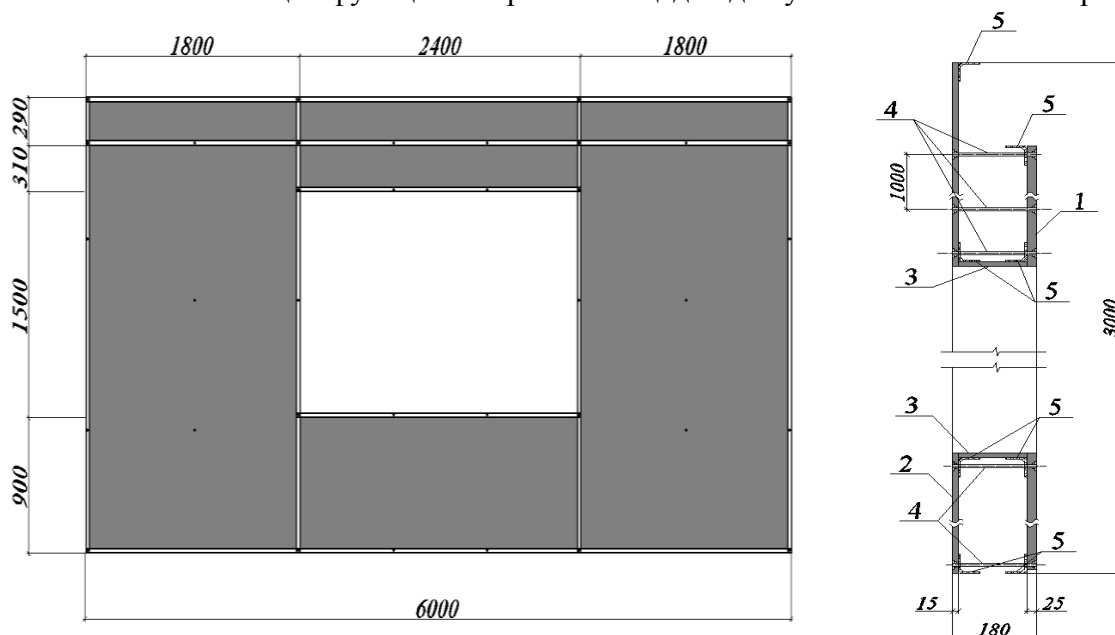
Пример стенового армоопалубочного блока жилого здания
